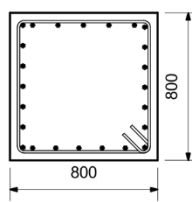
Detail Penulangan Kolom Gedung Tipe A
